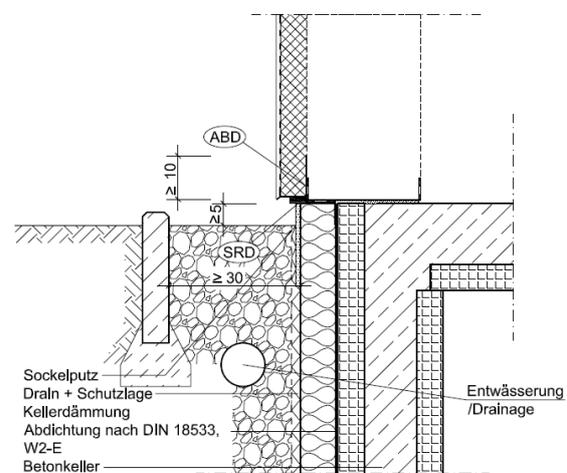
Kiesstreifen mit Putzfassade und Abdichtung gem. DIN 18533
